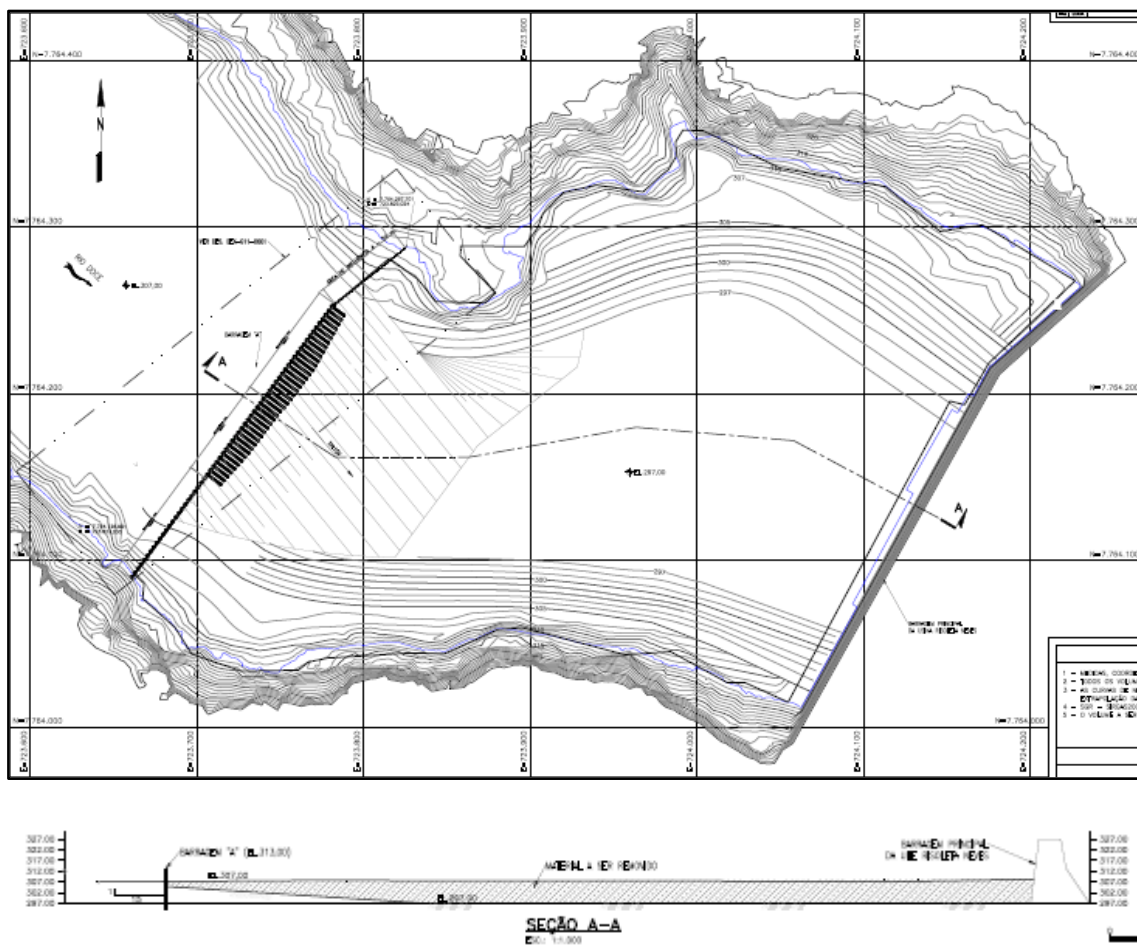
Planta e corte da dragagem da UHE Risoleta Neves
